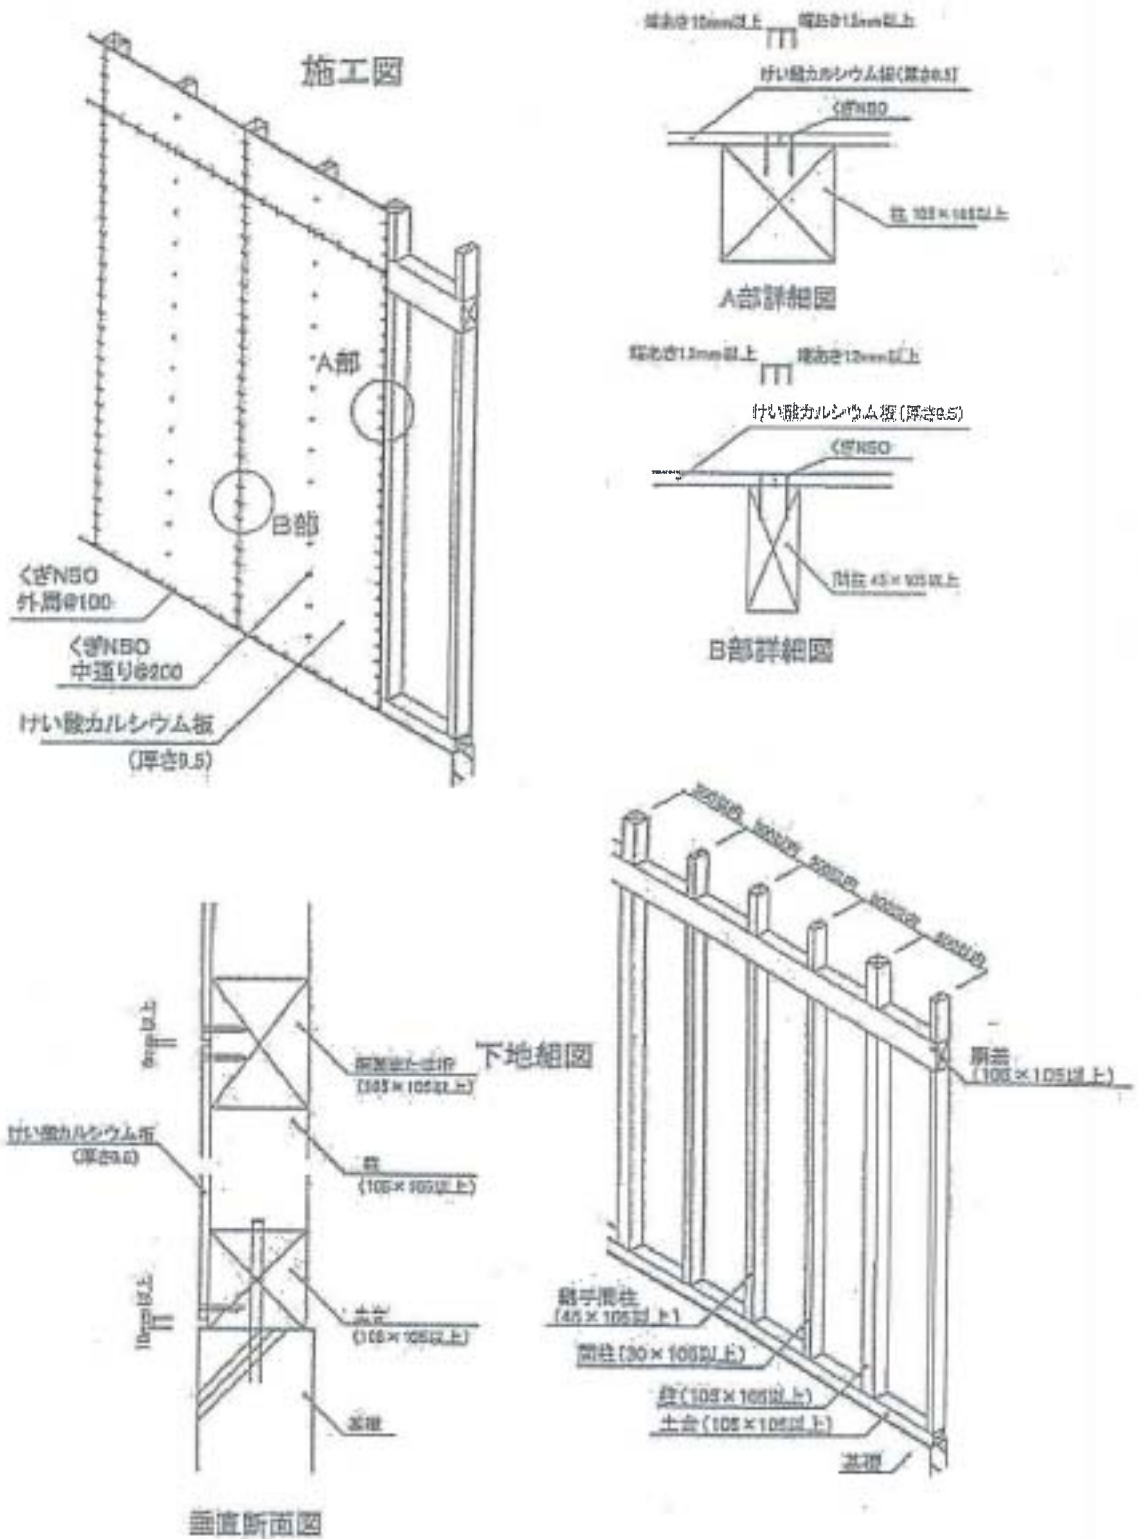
施工図：継手を設けない場合（寸法単位：mm）
